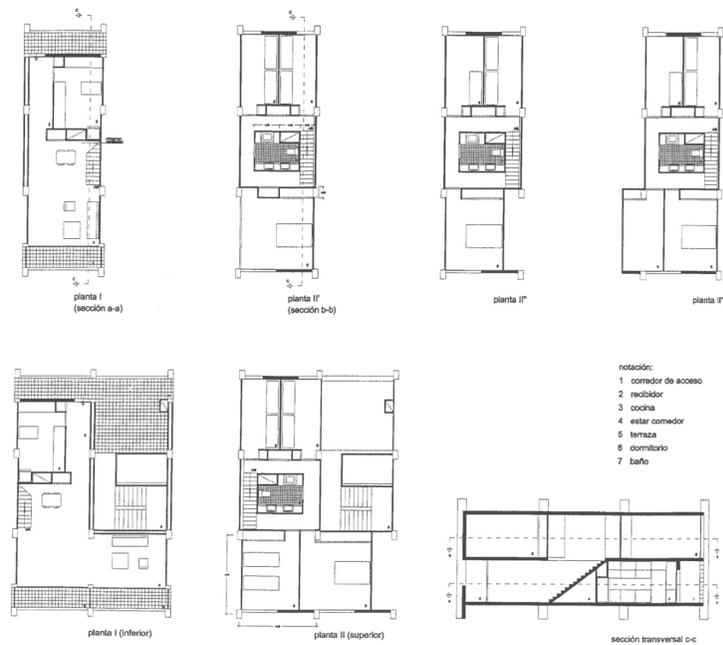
y 18. Planos en planta de las tipologías residenciales de Santa María Micaela de Santiago Artal. *Web de urbipedia.
